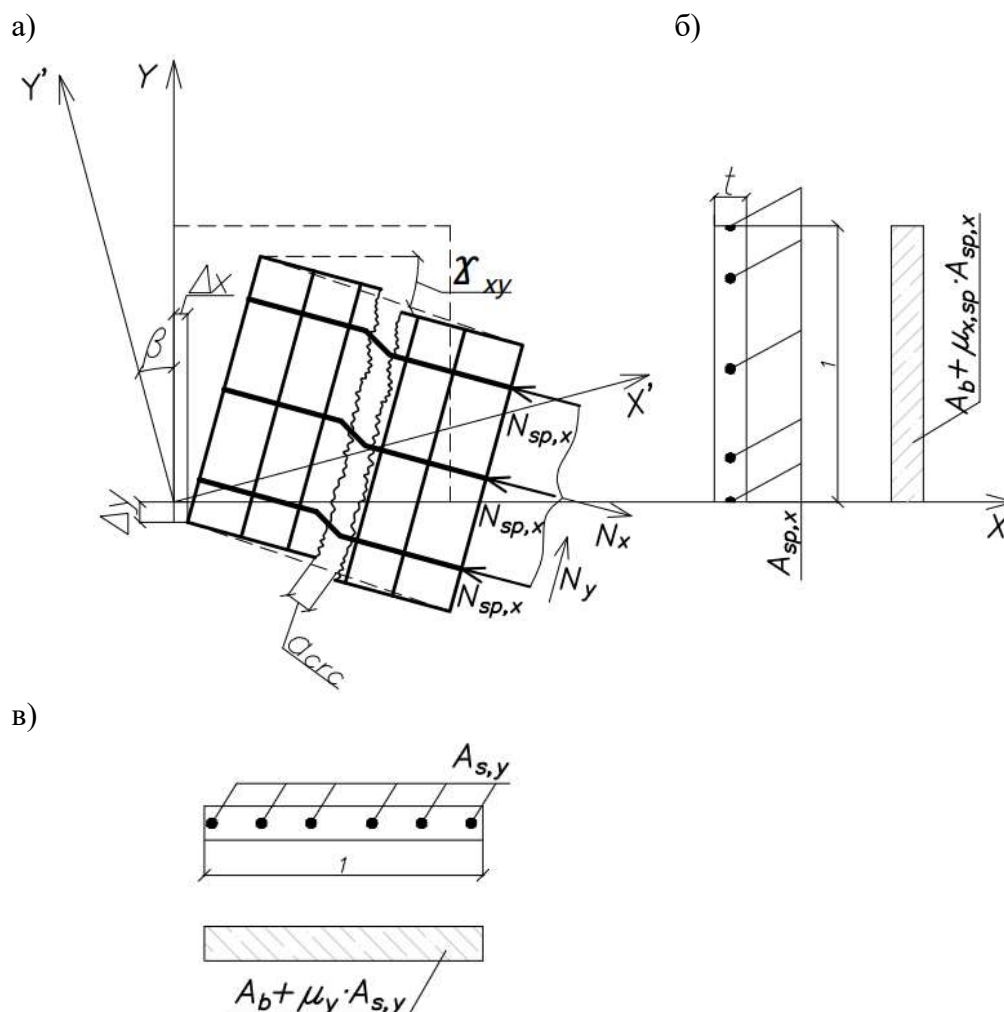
Расчетный предварительно напряженный железобетонный элемент с трещиной:
